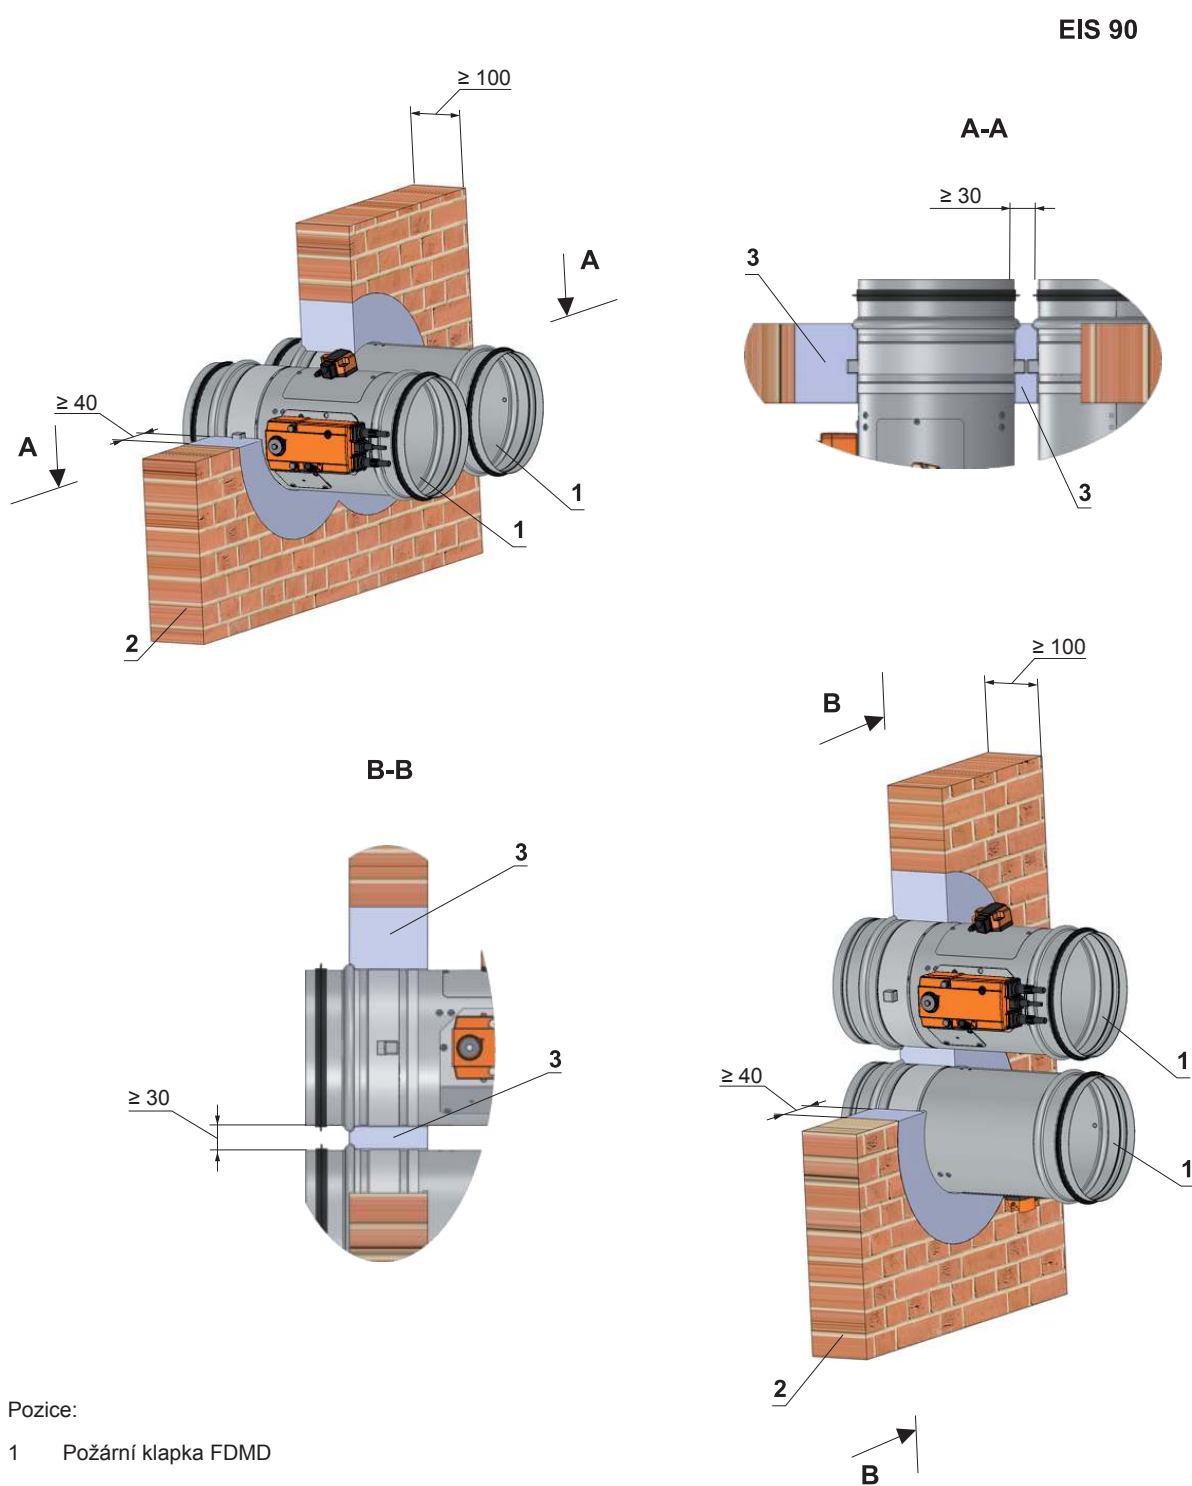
Tuhá stěnová konstrukce - sádra nebo malta
